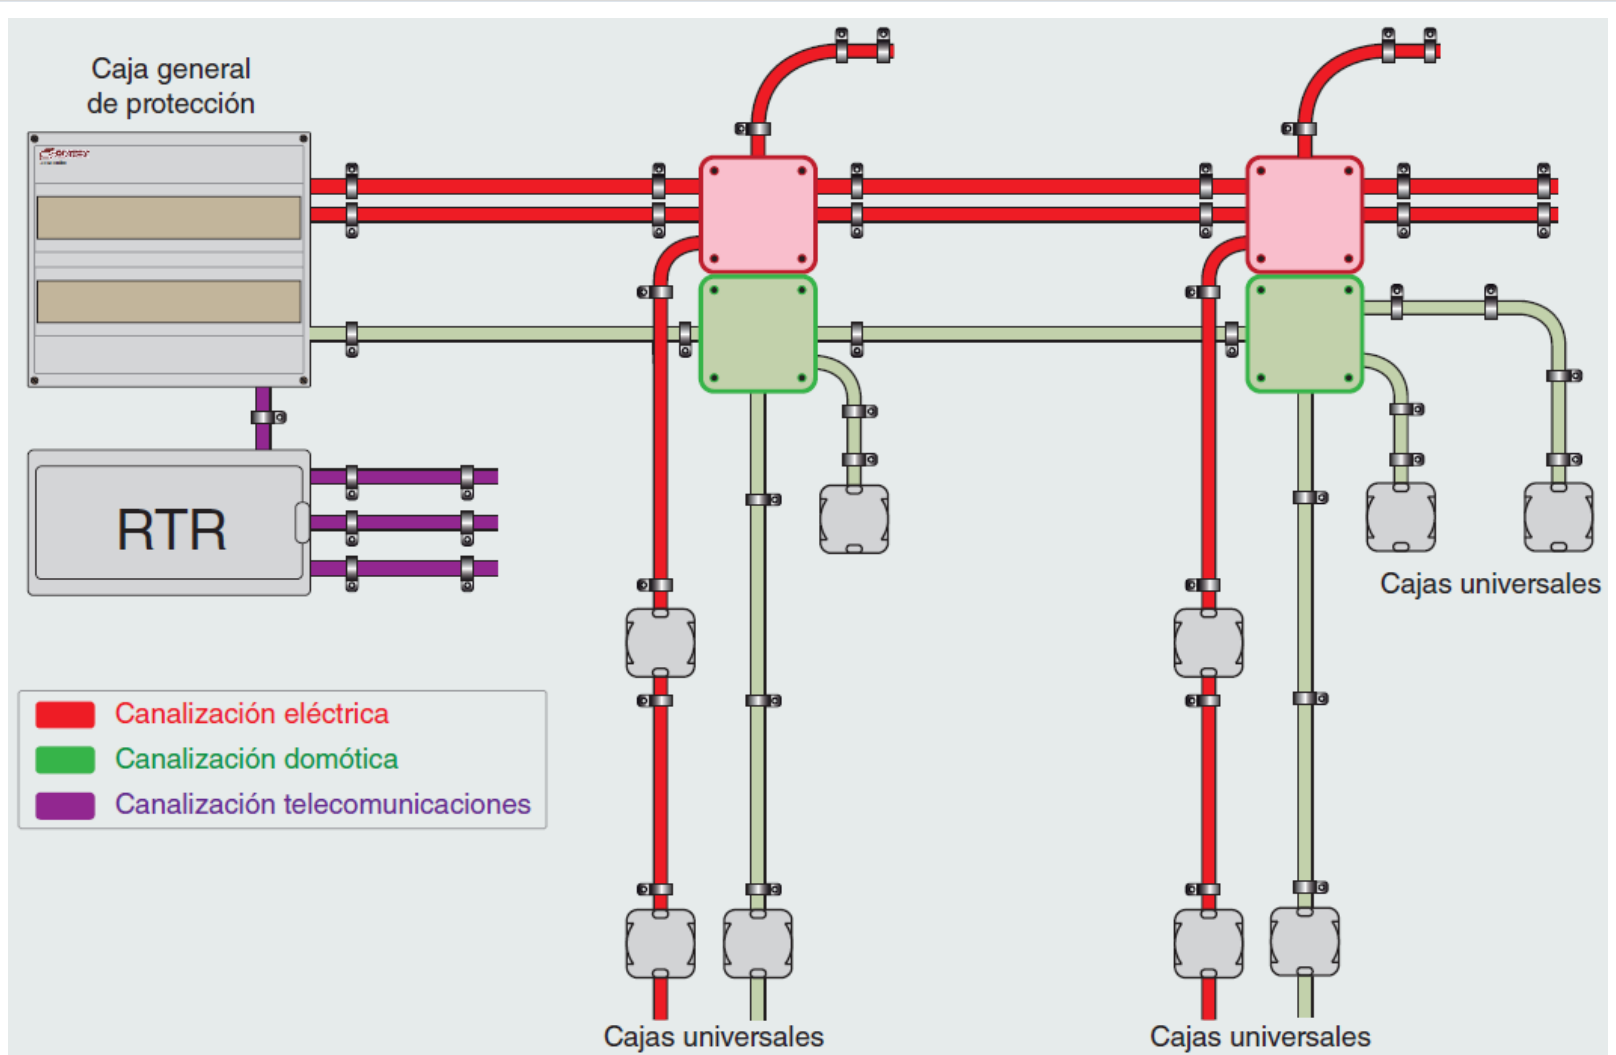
Detalles del montaje de las cajas de registro y la canalización.
